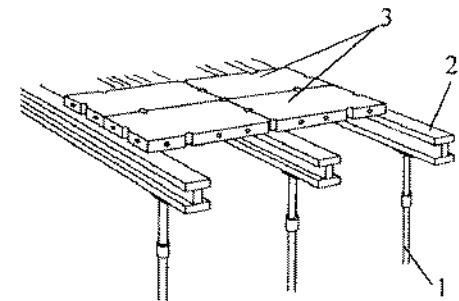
Опалубка перекрытий фирмы «Далли» по балкам Н20:
